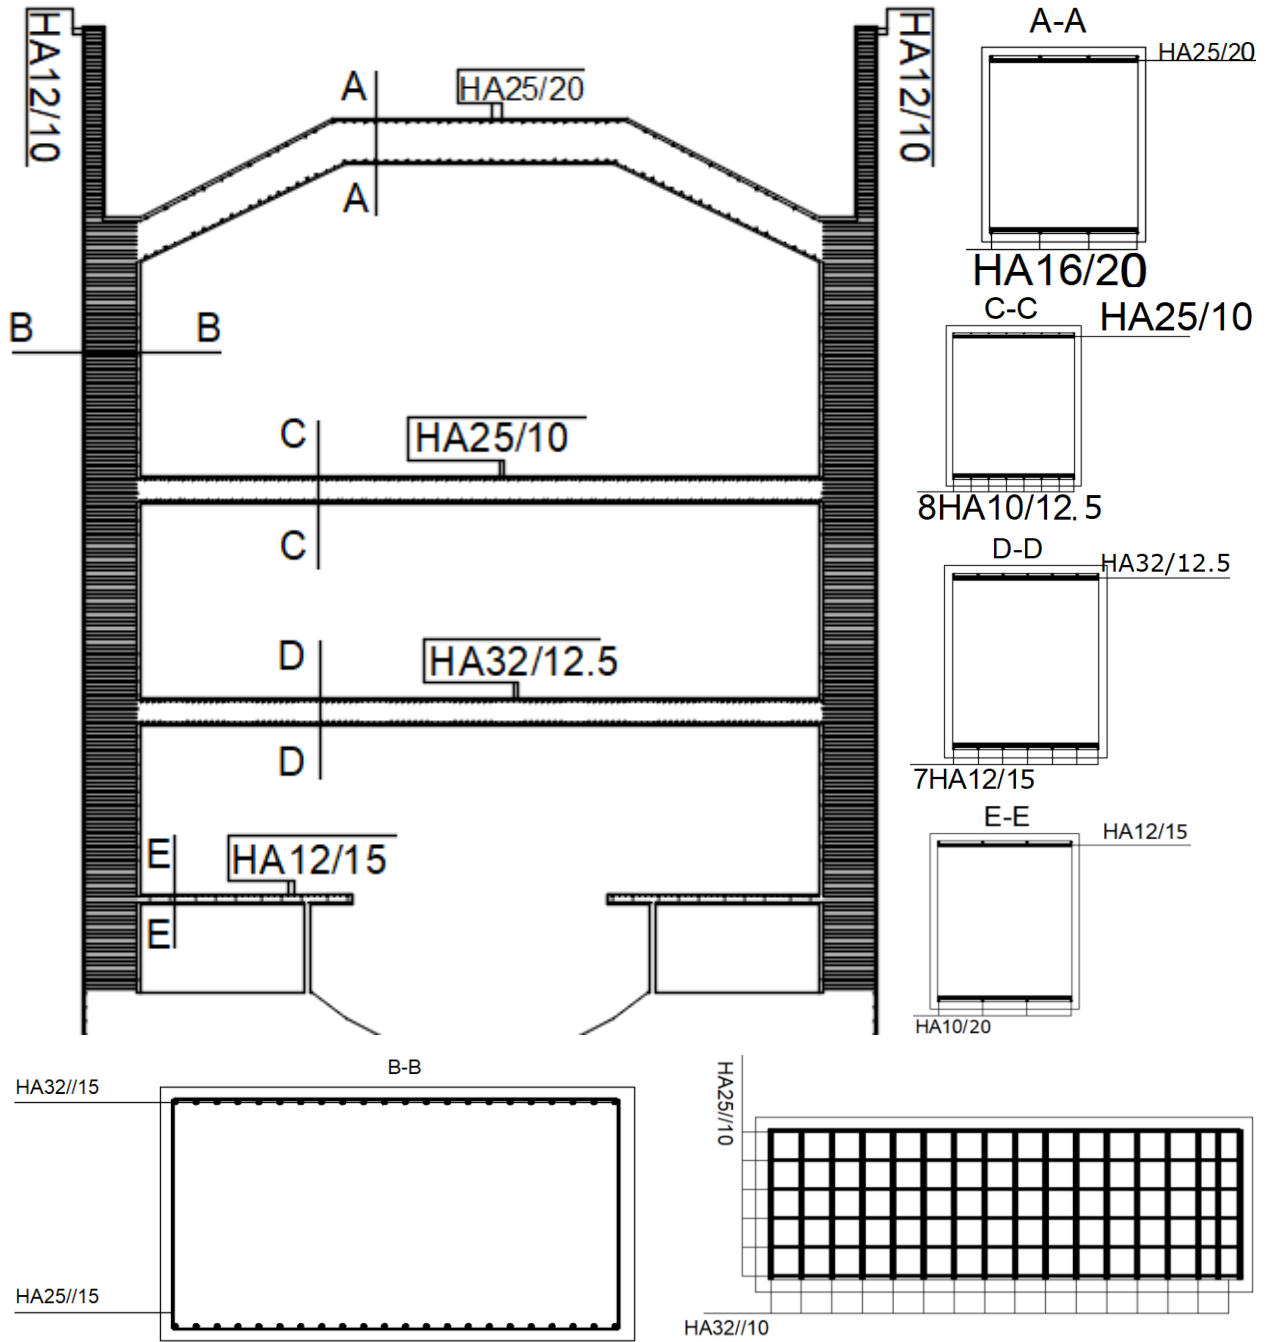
Schéma de ferrailage des éléments structuraux de la station
